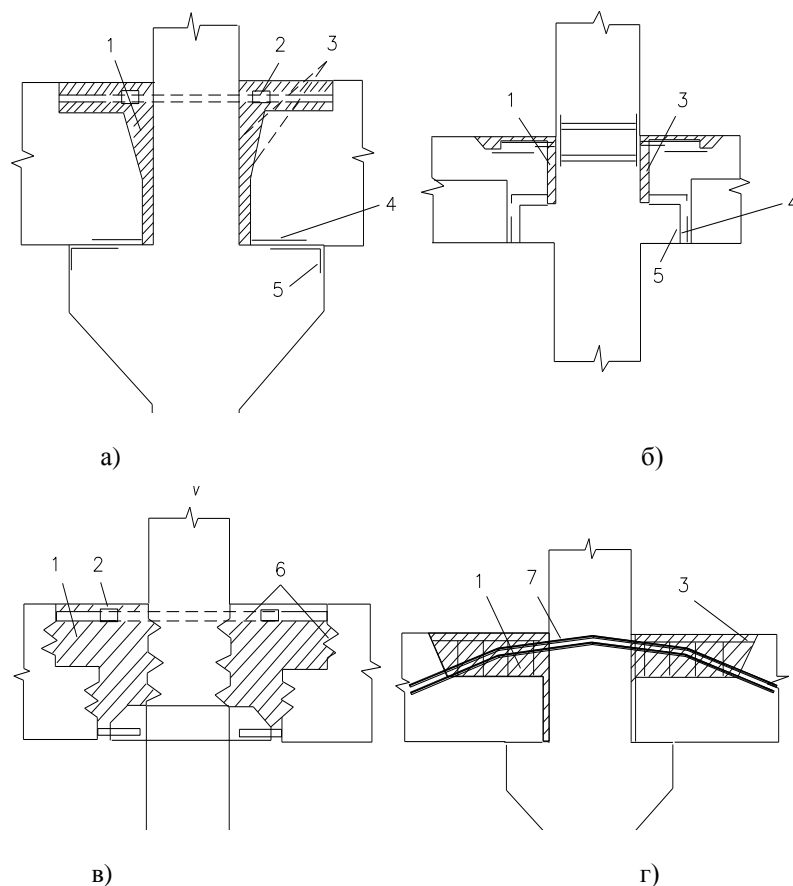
Стики ригелів з колонами: а) – жорсткий; б) – з прихованими консолями; в) – консольний з шпонками; г) – з напружуваною арматурою; 1 – бетон замонолічування; 2 – ванне зварювання; 3...5 – контакти відповідно: бетон-контактний шар-бетон; метал-метал; метал-бетон; 6 – шпоночний шов; 7 – напружена опорна арматура
